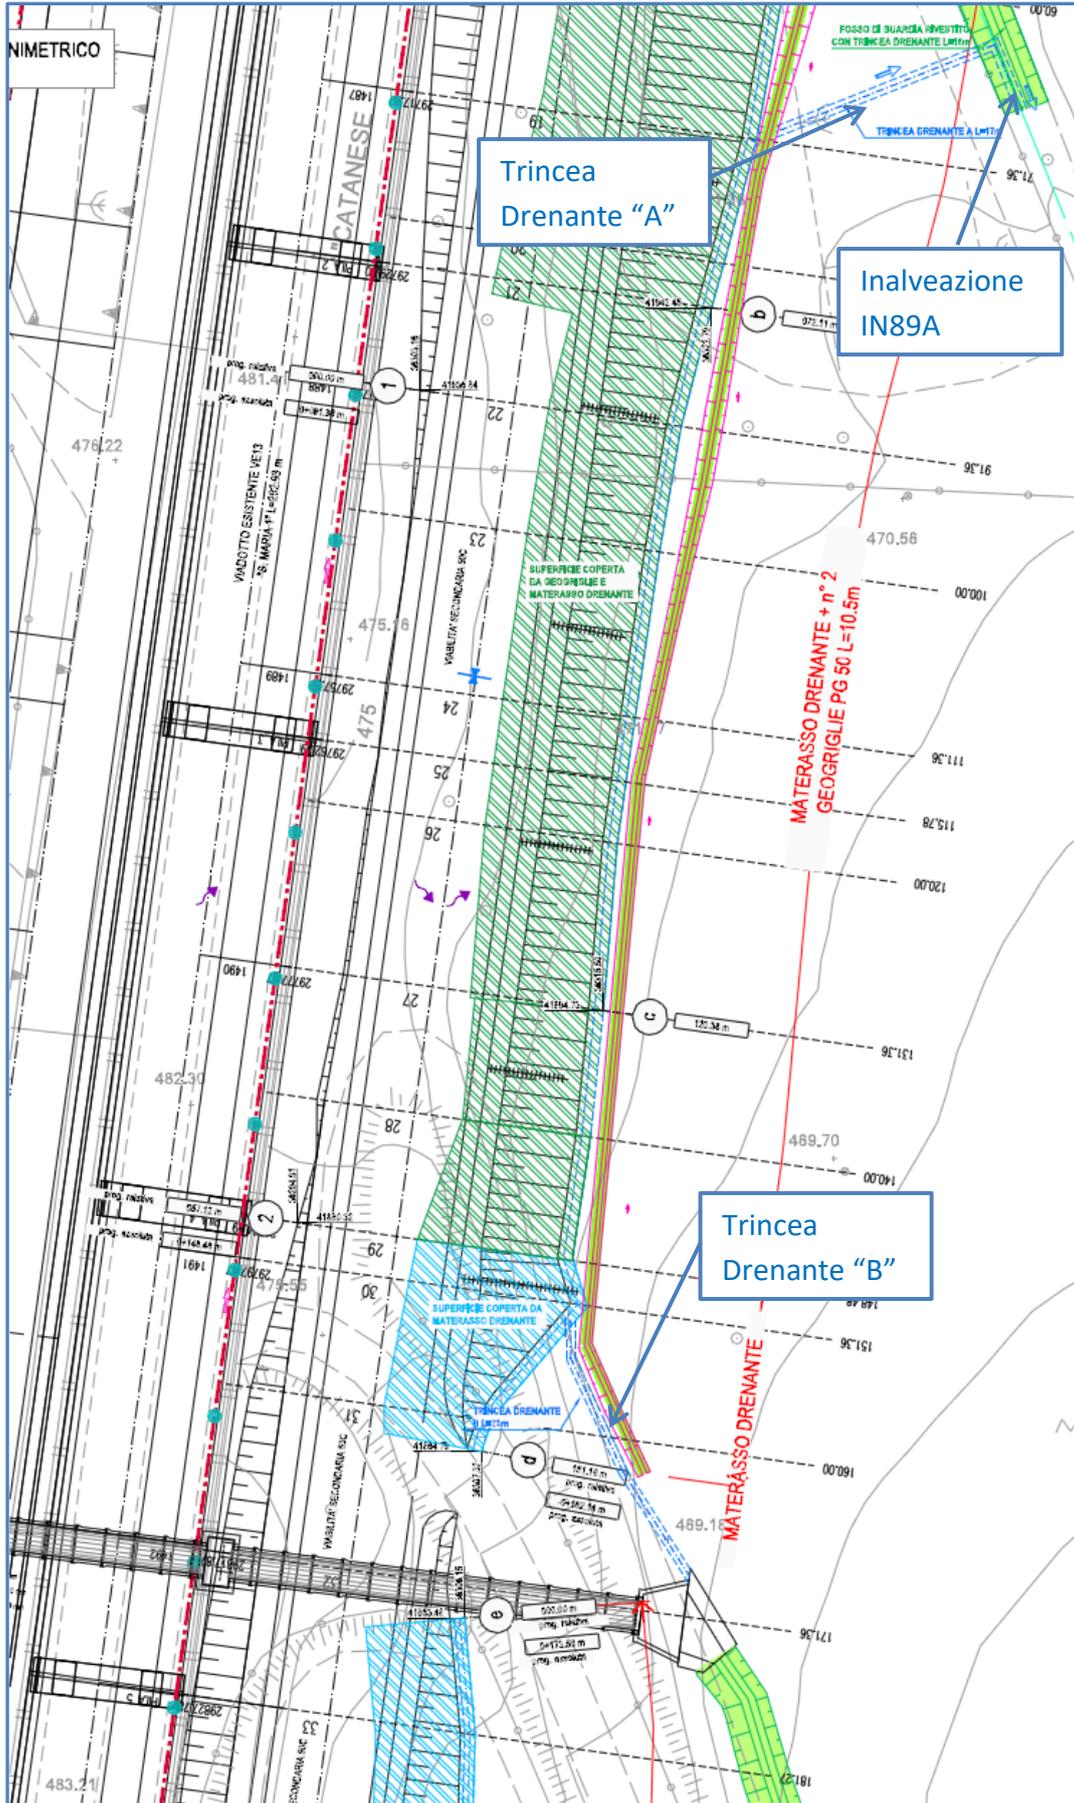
Stralcio planimetrico aggiornato (Elab. Codifica PVOS117A\_N001\_60\_4137).
